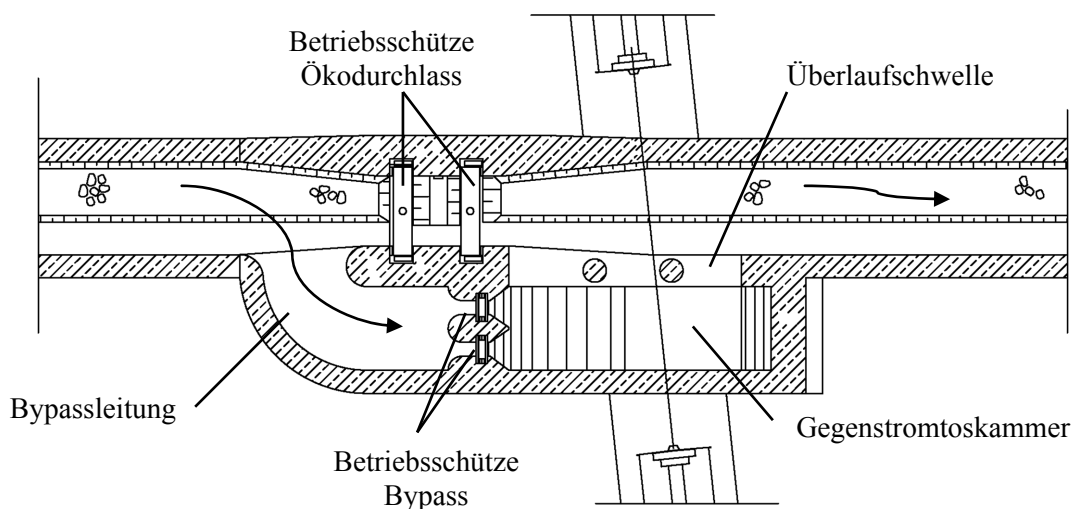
Grundriss des Gewässerdurchlasses mit der Bypassleitung mit der sich anschließenden Gegenstromtосkammer (BCE (2010), Modifikation IWD)
